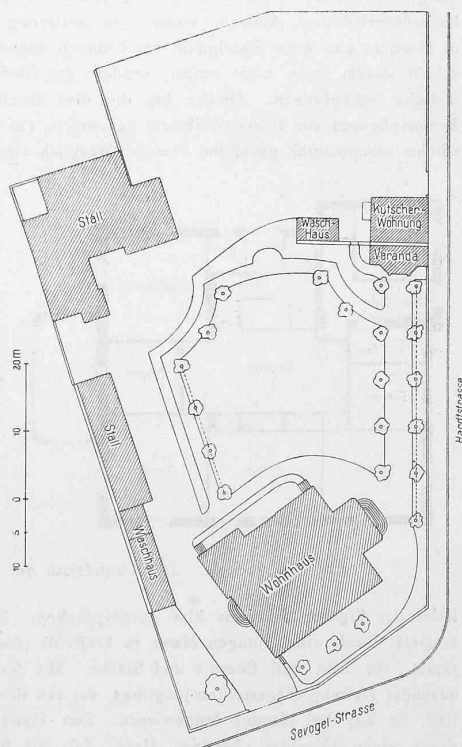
Lageplan der Villa R. V. B. — 1:1000
